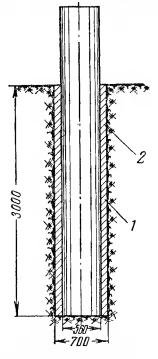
Нижняя часть железобетонной опоры без ригелей.
